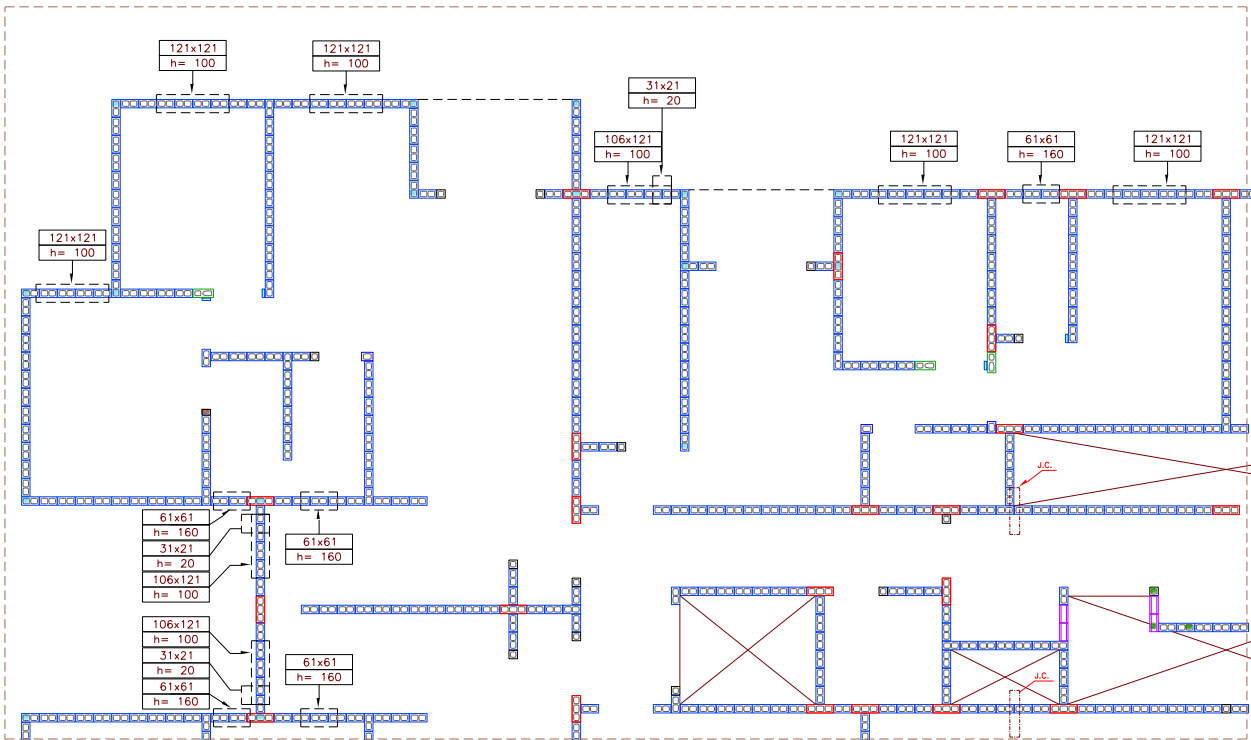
Edifício Way Peña: detalhe da planta de modulação
